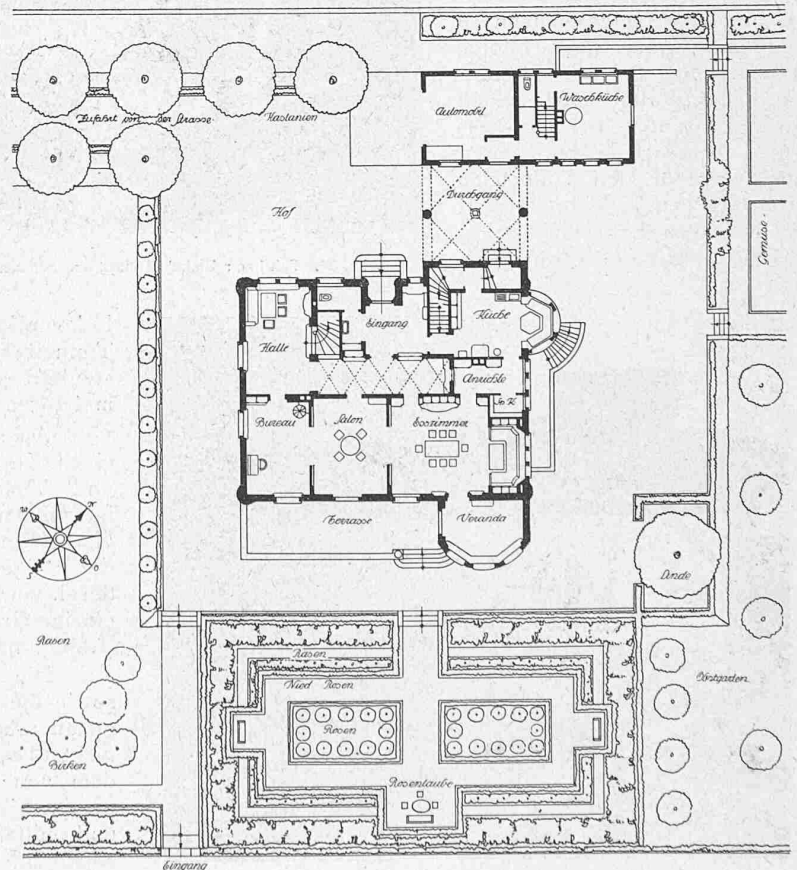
Lage- und Gartenplan zum Hause E. Wirz-Schwarzer in Langenthal mit Erdgeschoss-Grundriss. — Masstab 1:400.
